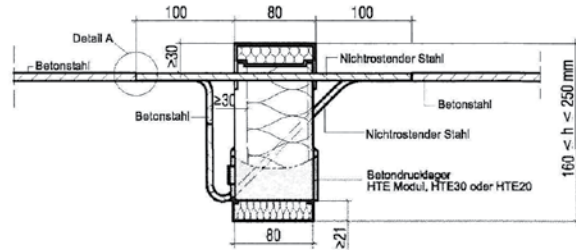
Schöck Isokorb Typ K¹⁾ mit integrierter Aufhängebewehrung gem. Abschn. 3.3.1
